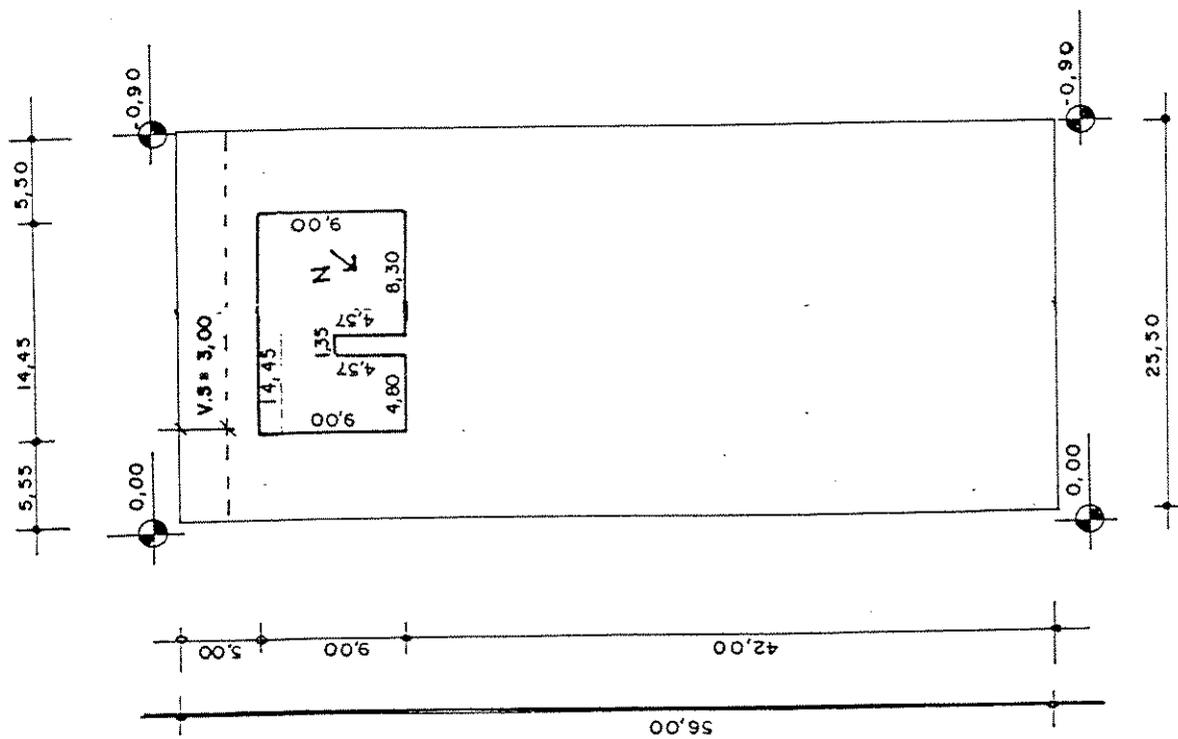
Planta baixa da Edificação 05. Fonte: Elaboração própria.
